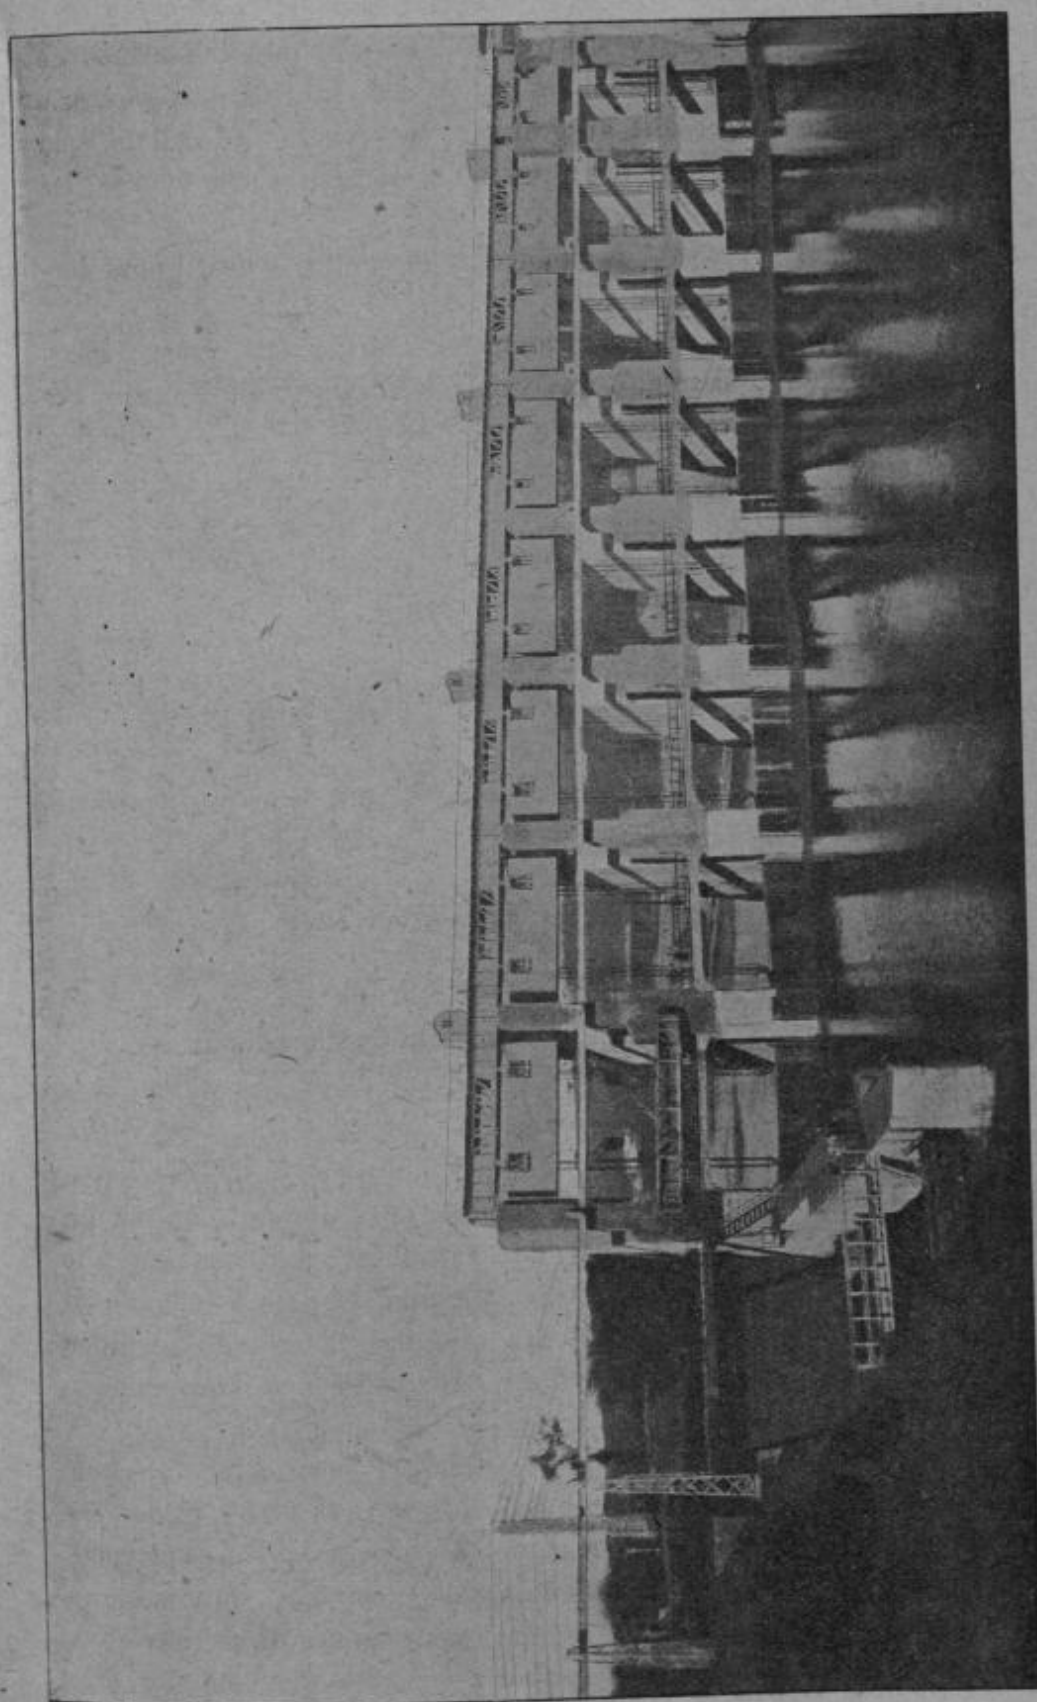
Usine de Tullière. — Vue générale du barrage.
